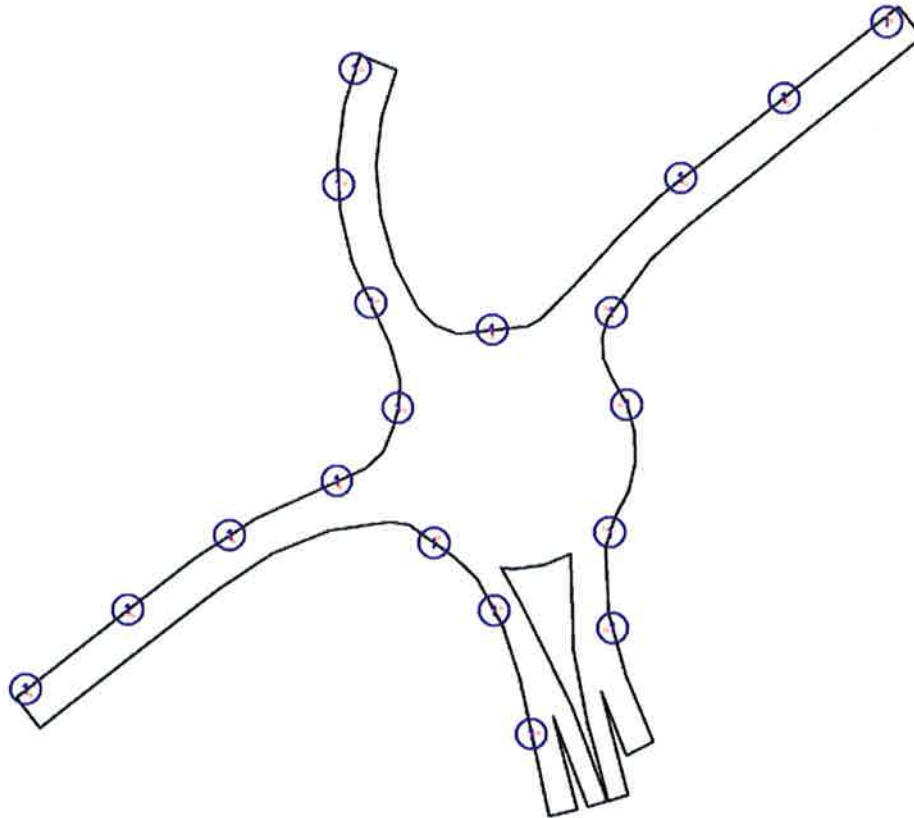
Planimetria con disposizione apparecchi illuminanti
